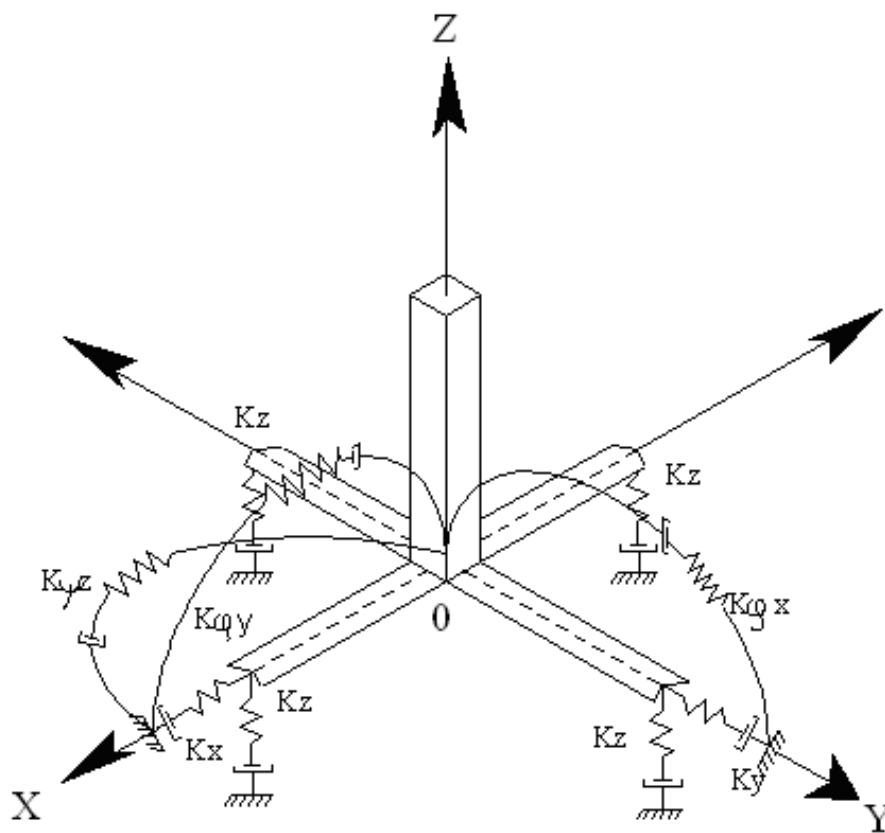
Esquema espacial de cálculo de la cimentación tipo zapata aislada
